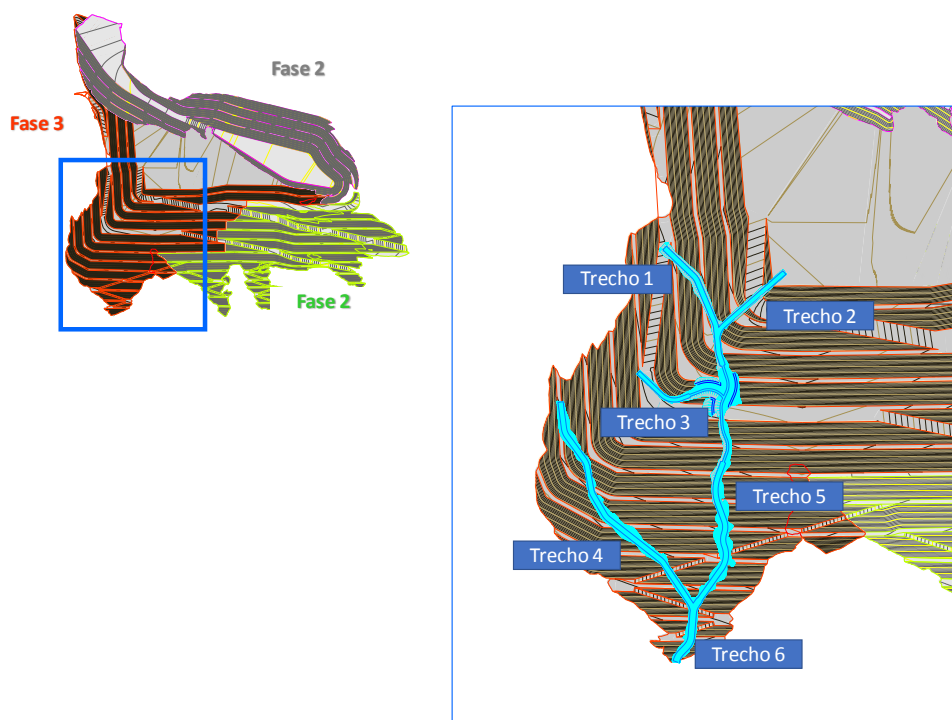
Planta de localização dos drenos de fundo da PDE Extrativa – Fase3.
